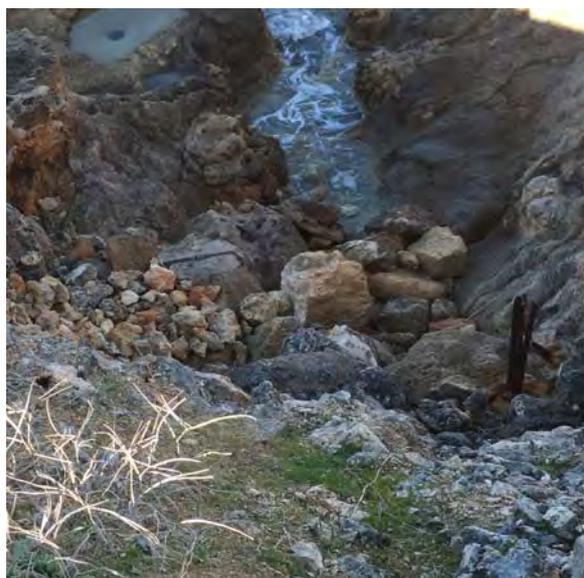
Es Caló de la Reina zona de varada preexistente.
